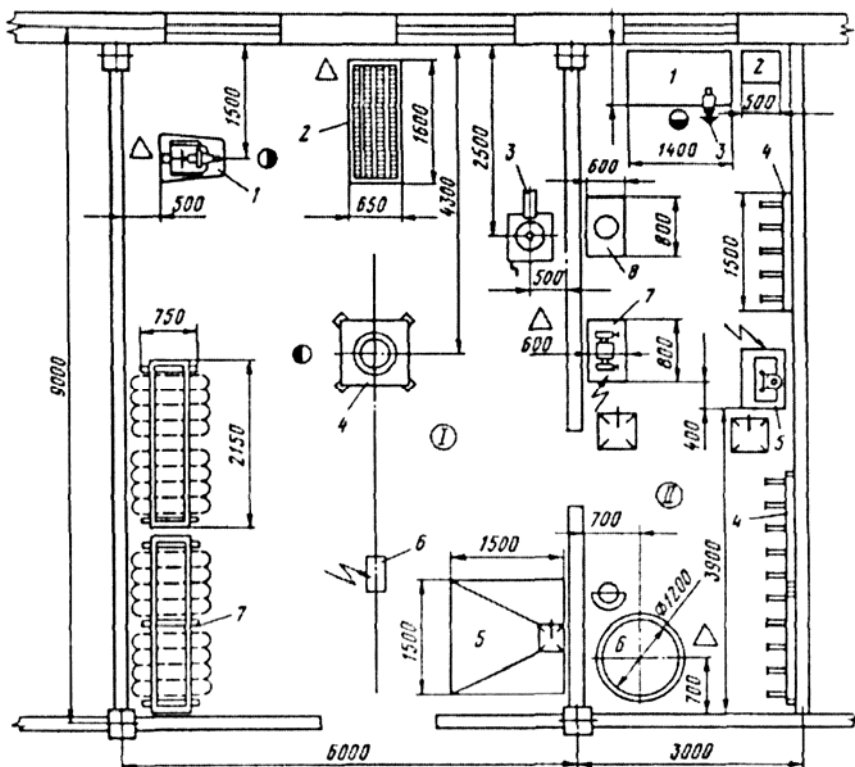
Шиномонтажный и вулканизационный участки АТП на 250 автомобилей: I – шиномонтажный участок: 1 – пневматический спредер; 2 – клеть для накачки шин; 3 – стенд для правки дисков колес; 4 – стенд для демонтажа шин; 5 – камера для окраски дисков колес; 6 – тельфер; 7 – одноярусный стеллаж для покрышек; II – вулканизационный участок: 1 – верстак; 2 – ларь для отходов; 3 – слесарные тиски; 4 – настенные вешалки для камер; 5 – электровулканизационный аппарат для ремонта камер; 6 – ванна для проверки камер; 7 – шероховальный станок; 8 – ручная клеешалка
